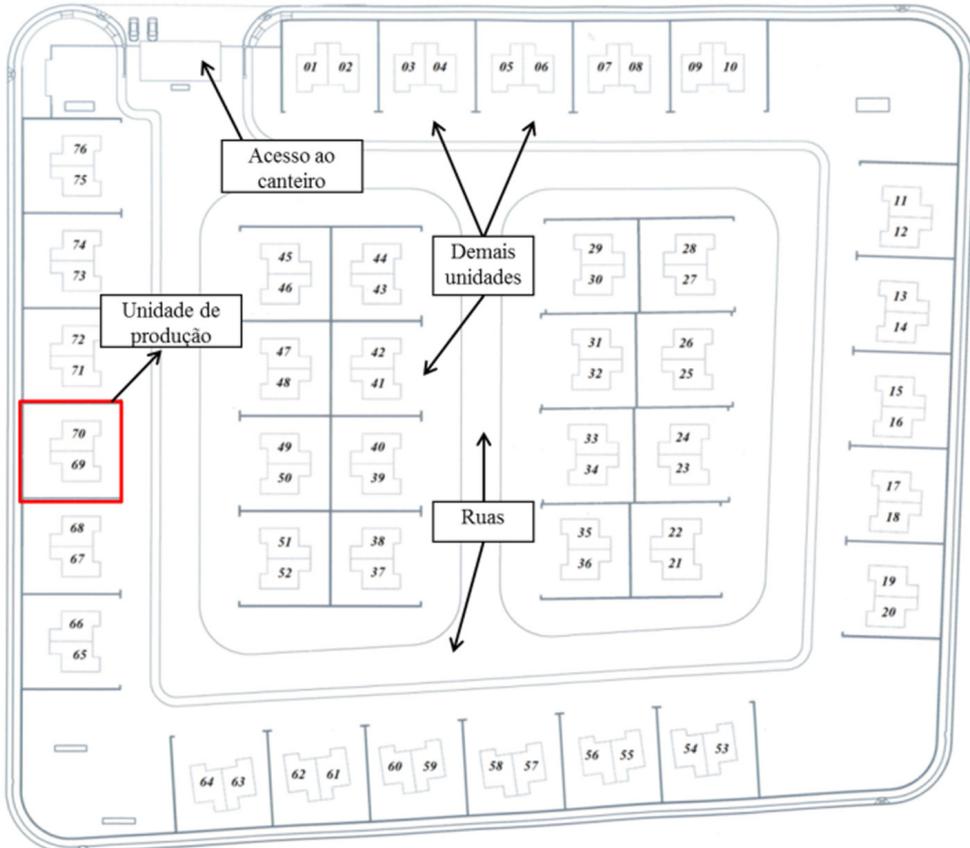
Layout do canteiro de obras do empreendimento. Fonte: Autores.
